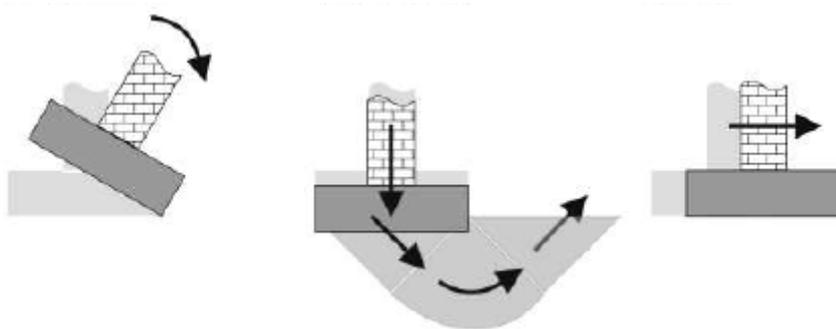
Fallas por Volcamiento, Capacidad de Soporte y Deslizamiento, Respectivamente
